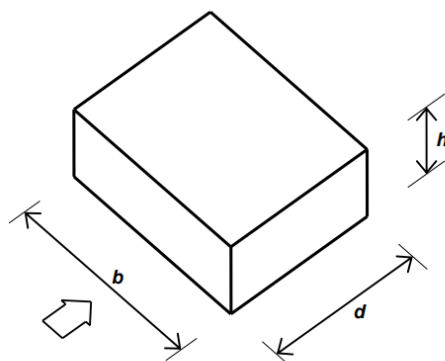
Parametri caratteristici di edifici a pianta rettangolare.
